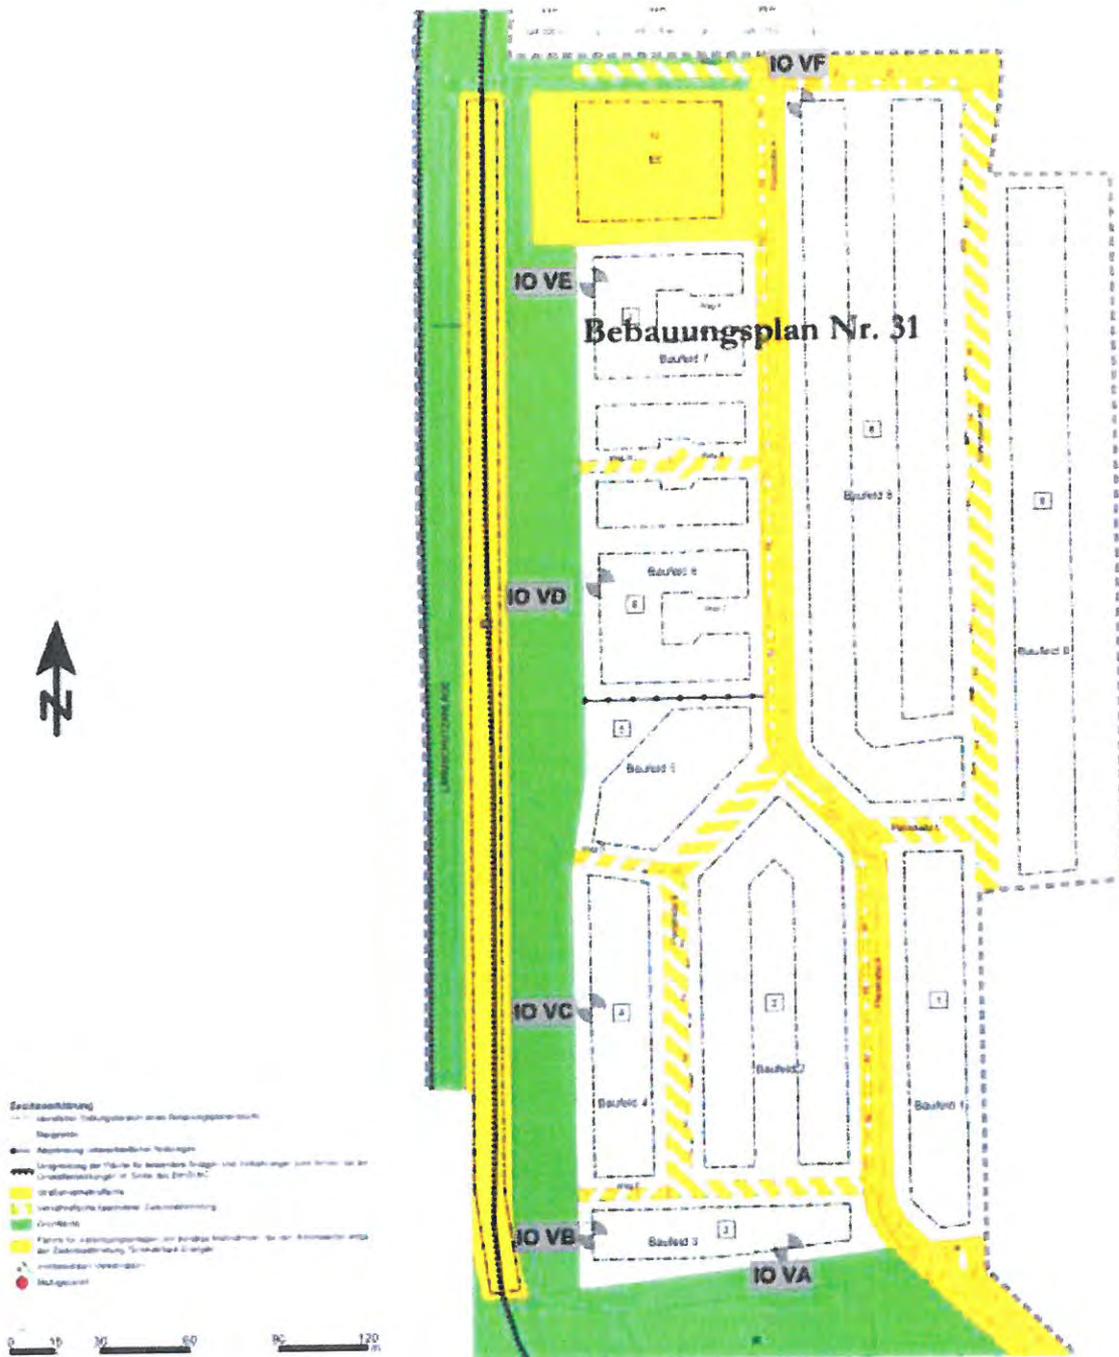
Lageplan mit Immissionsorten für die Verkehrslärberechnungen (IO Vx)
